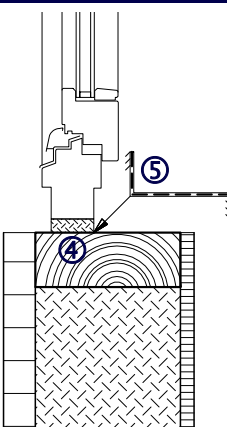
Die Fuge zwischen Fenster und Rohbauwand beträgt auch hier 15 mm und wird mit elastischem Dämmmaterial ④ ausgefüllt (z. B. Faserdämmstoff). Die Luftdichtung / Dampfbremse ⑤ wird zum Fensterbankfalz verklebt.
